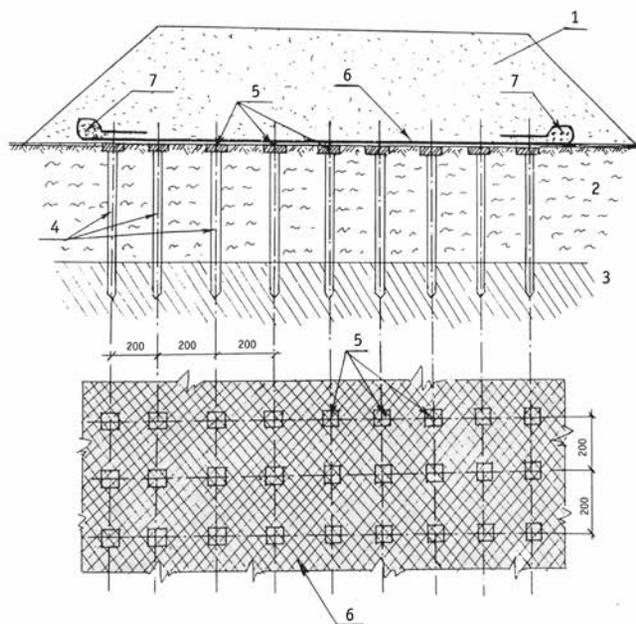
Схема «безосадочной» насыпи на слабом основании: а – поперечный разрез; б – план армогрунтовой ростверка; 1 – тело насыпи; 2 – слабые грунты основания; 3 – более прочные грунты основания; 4 – забивные железобетонные сваи сечением 35х35см; 5 – железобетонные сборные оголовники свай; 6 – армогрунтовый ростверк в виде мембраны из высокопрочной геосинтетической ткани Stablenka; 7 – анкерные элементы
